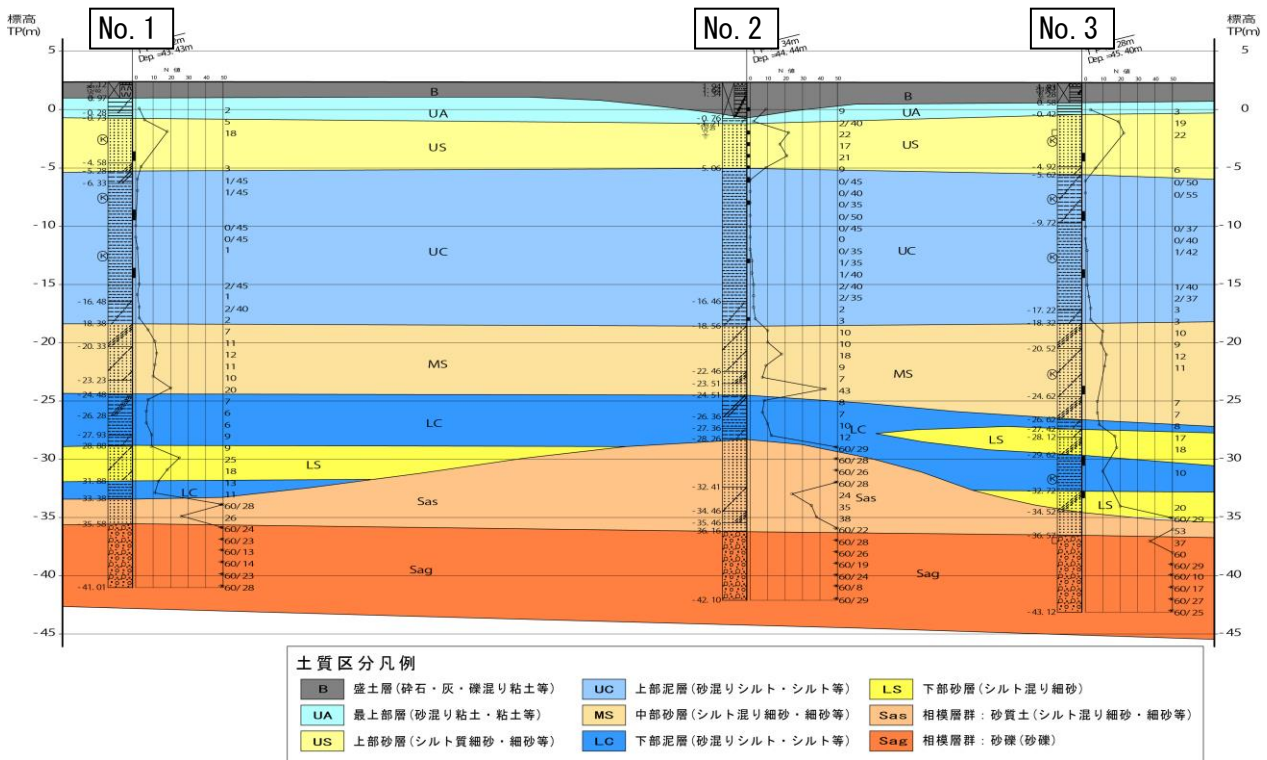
(1) 想定地質断面図 (断面 1)
